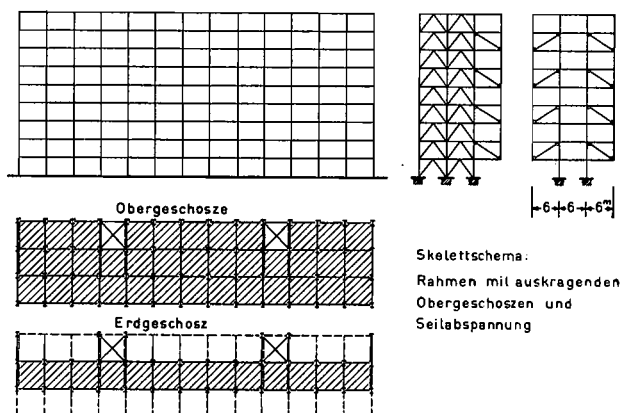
Variante 6, zweistöckiger Rahmen mit auskragenden Obergeschossen
